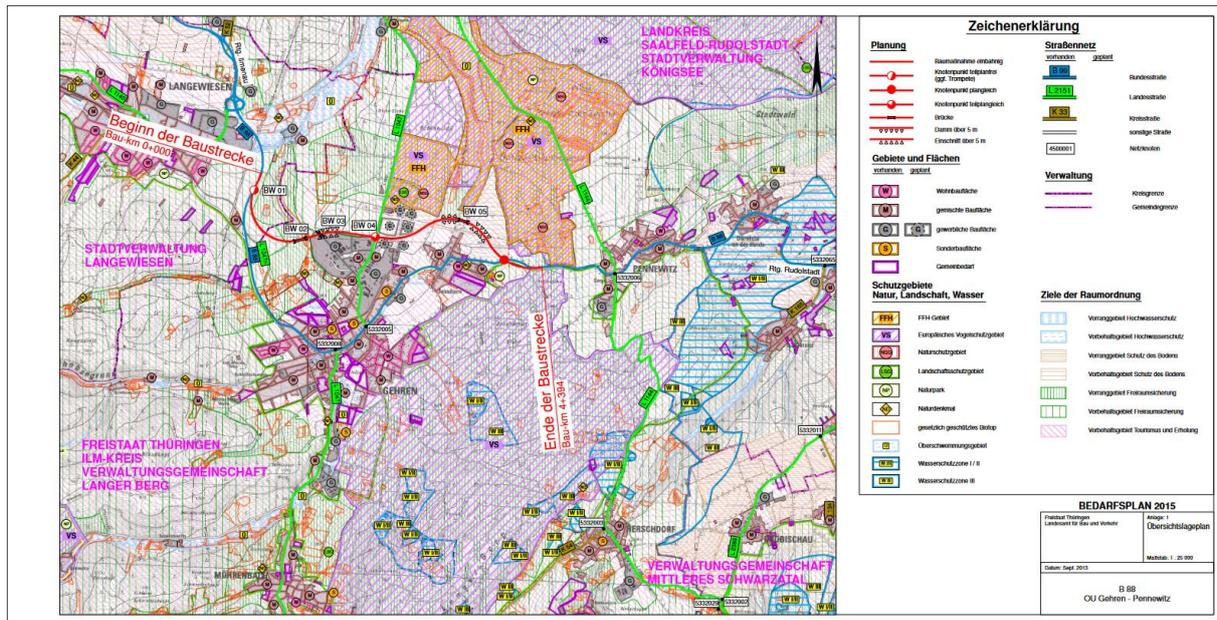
Planung OU Gehren – Pennewitz⁵⁷
